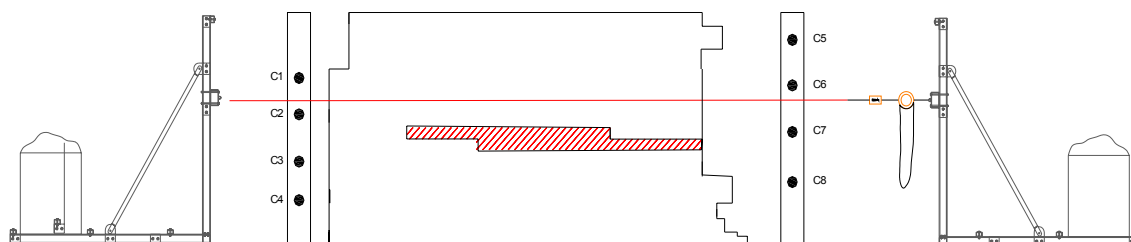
Esquema de ensaio da parede *in-situ*.
